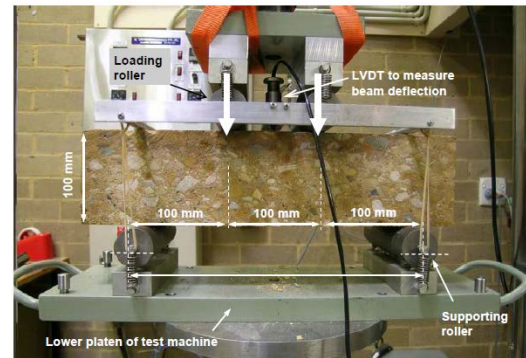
Ensayo de viga a flexión. Fuente: Austroads.
